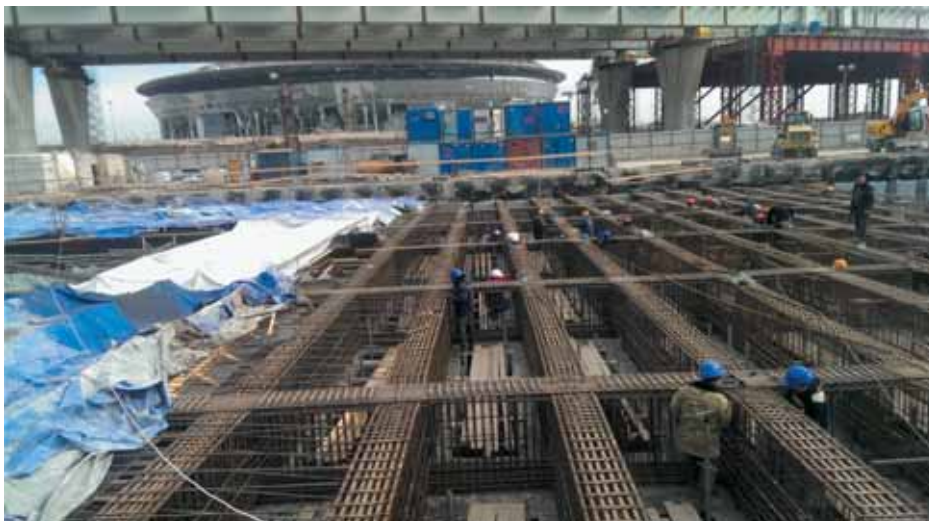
В пролете покрытие опирается на два ряда свай-колонн
